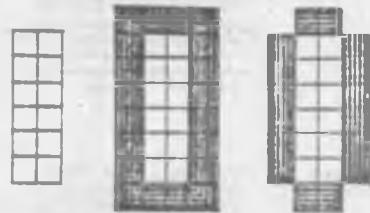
Виды сечений колонн и опорных элементов бетонных зданий к центровому типу
